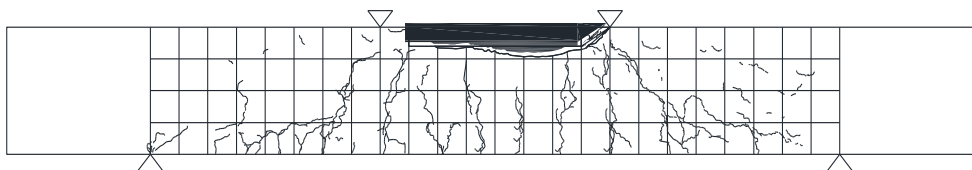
補修付着良好梁試験体のひび割れ状況
